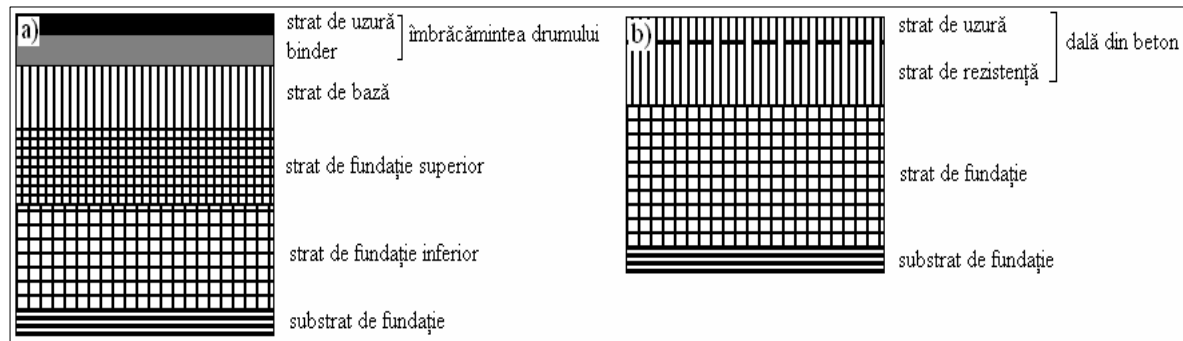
Tipuri de alcătuiți de structuri rutiere: a) structură flexibilă; b) structură rigidă.
